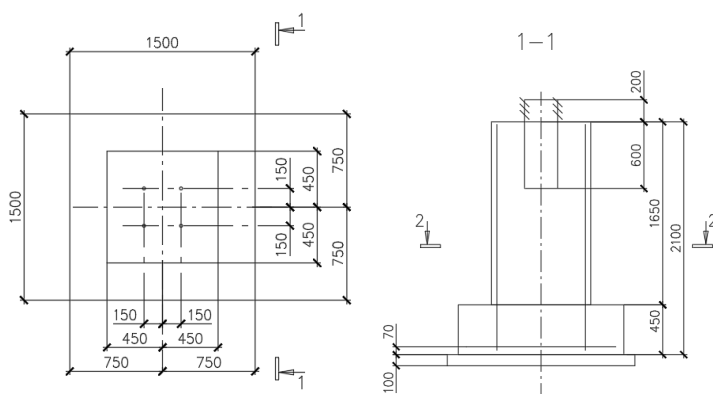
Фундамент монолитный ФМ-1 (1,5х1,5 м)
